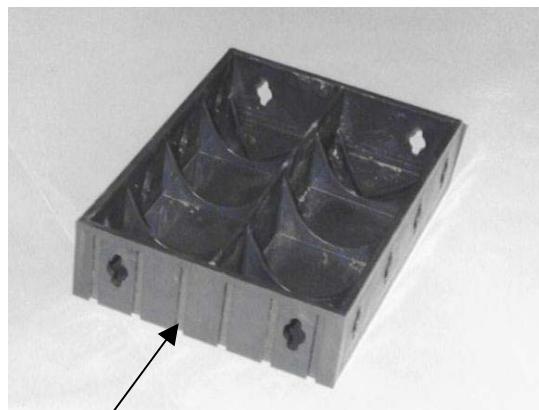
Detalhe da "rainhura" para encaixe de outra placa e furo para colocar chaveta (Fonte: Betonform).
